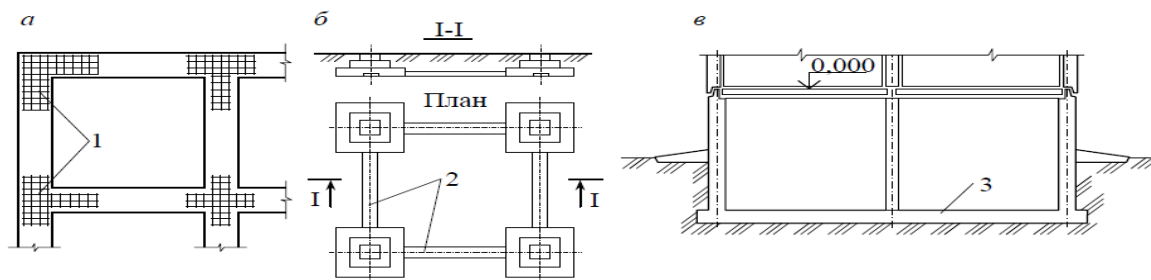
Конструкції фундаментів при сейсмічних впливах: а – план стрічкового фундаменту; б – план і розріз стовпчастих фундаментів; в – підвальна частина будинку з плитним фундаментом; 1 – арматурні сітки; 2 – фундаментні балки; 3 – плита з монолітного залізобетону
